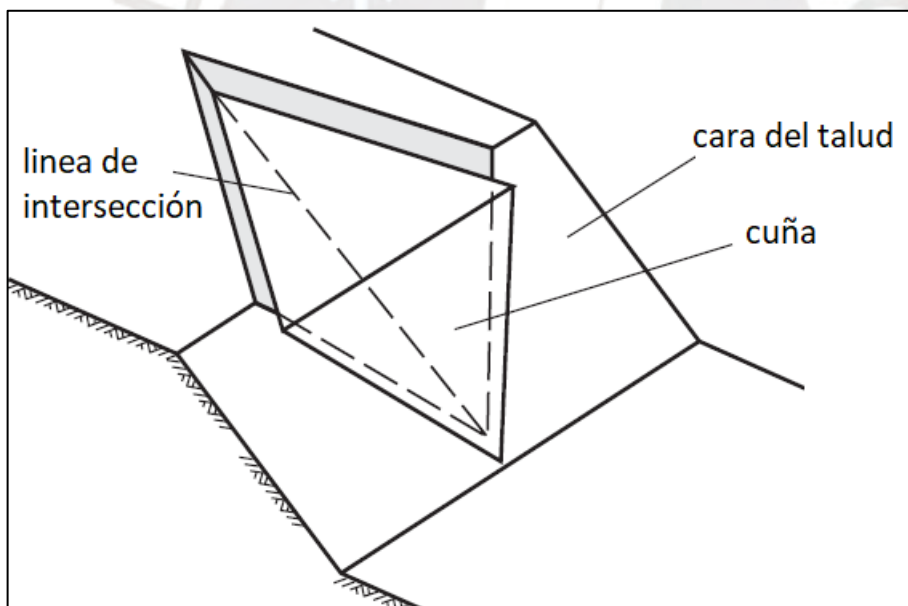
Componentes de las fallas tipo cuña. Adaptado de Read & Stacey, 2009
